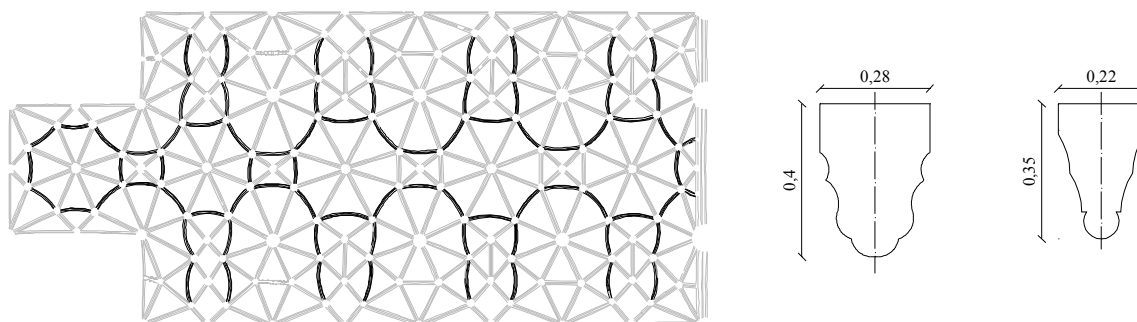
Intradorso da abóbada da nave e secção transversal das nervuras (a negro indicam-se as nervuras com perfil de menor dimensão) (Genin, 1995).
